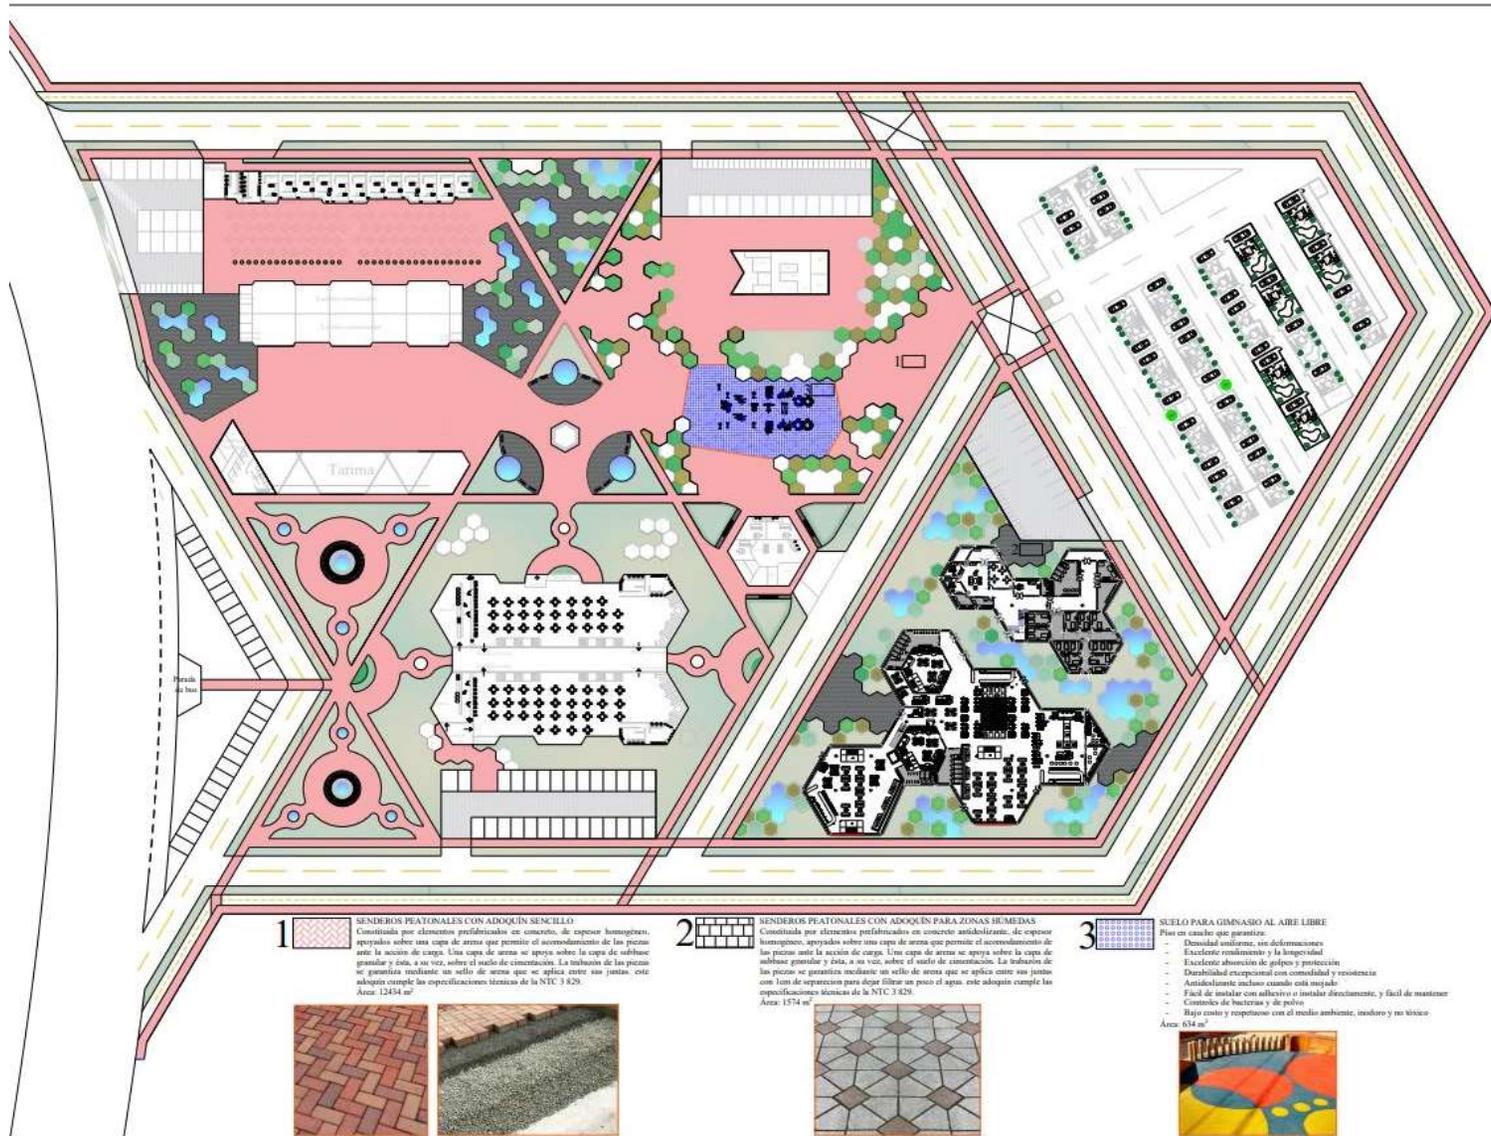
Planimetría urbana. Fuente: elaboración propia
